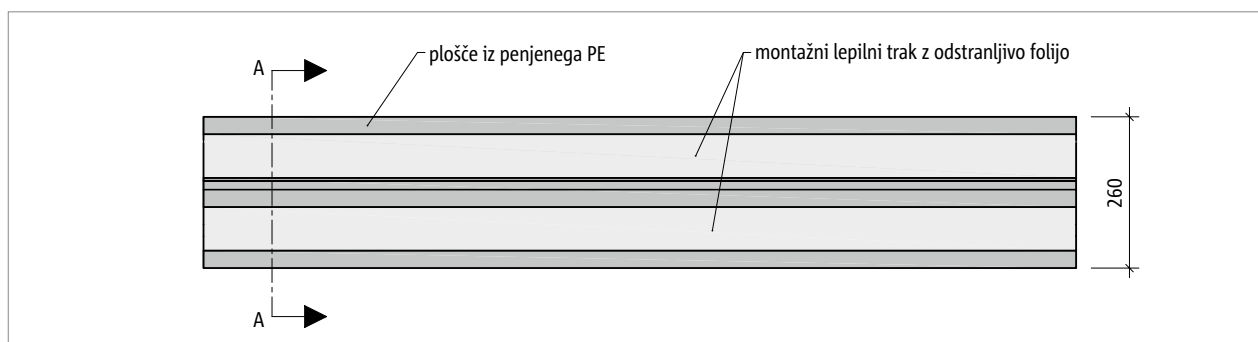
Schöck Tronsole® tip F: razvrstitev elementov, detajl B
